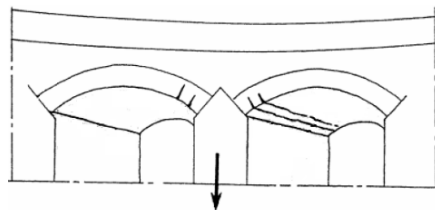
Tipos de fissuras nos arcos devido ao movimento dos apoios (IQOA 1996)
